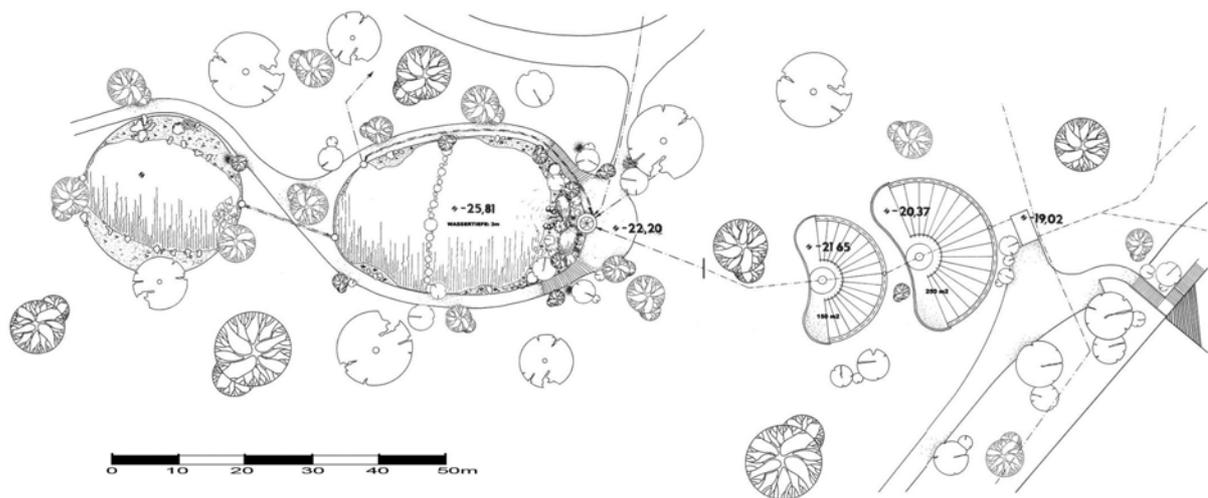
Pflanzenkläranlage Schloss Ernstbrunn – Lageplan
